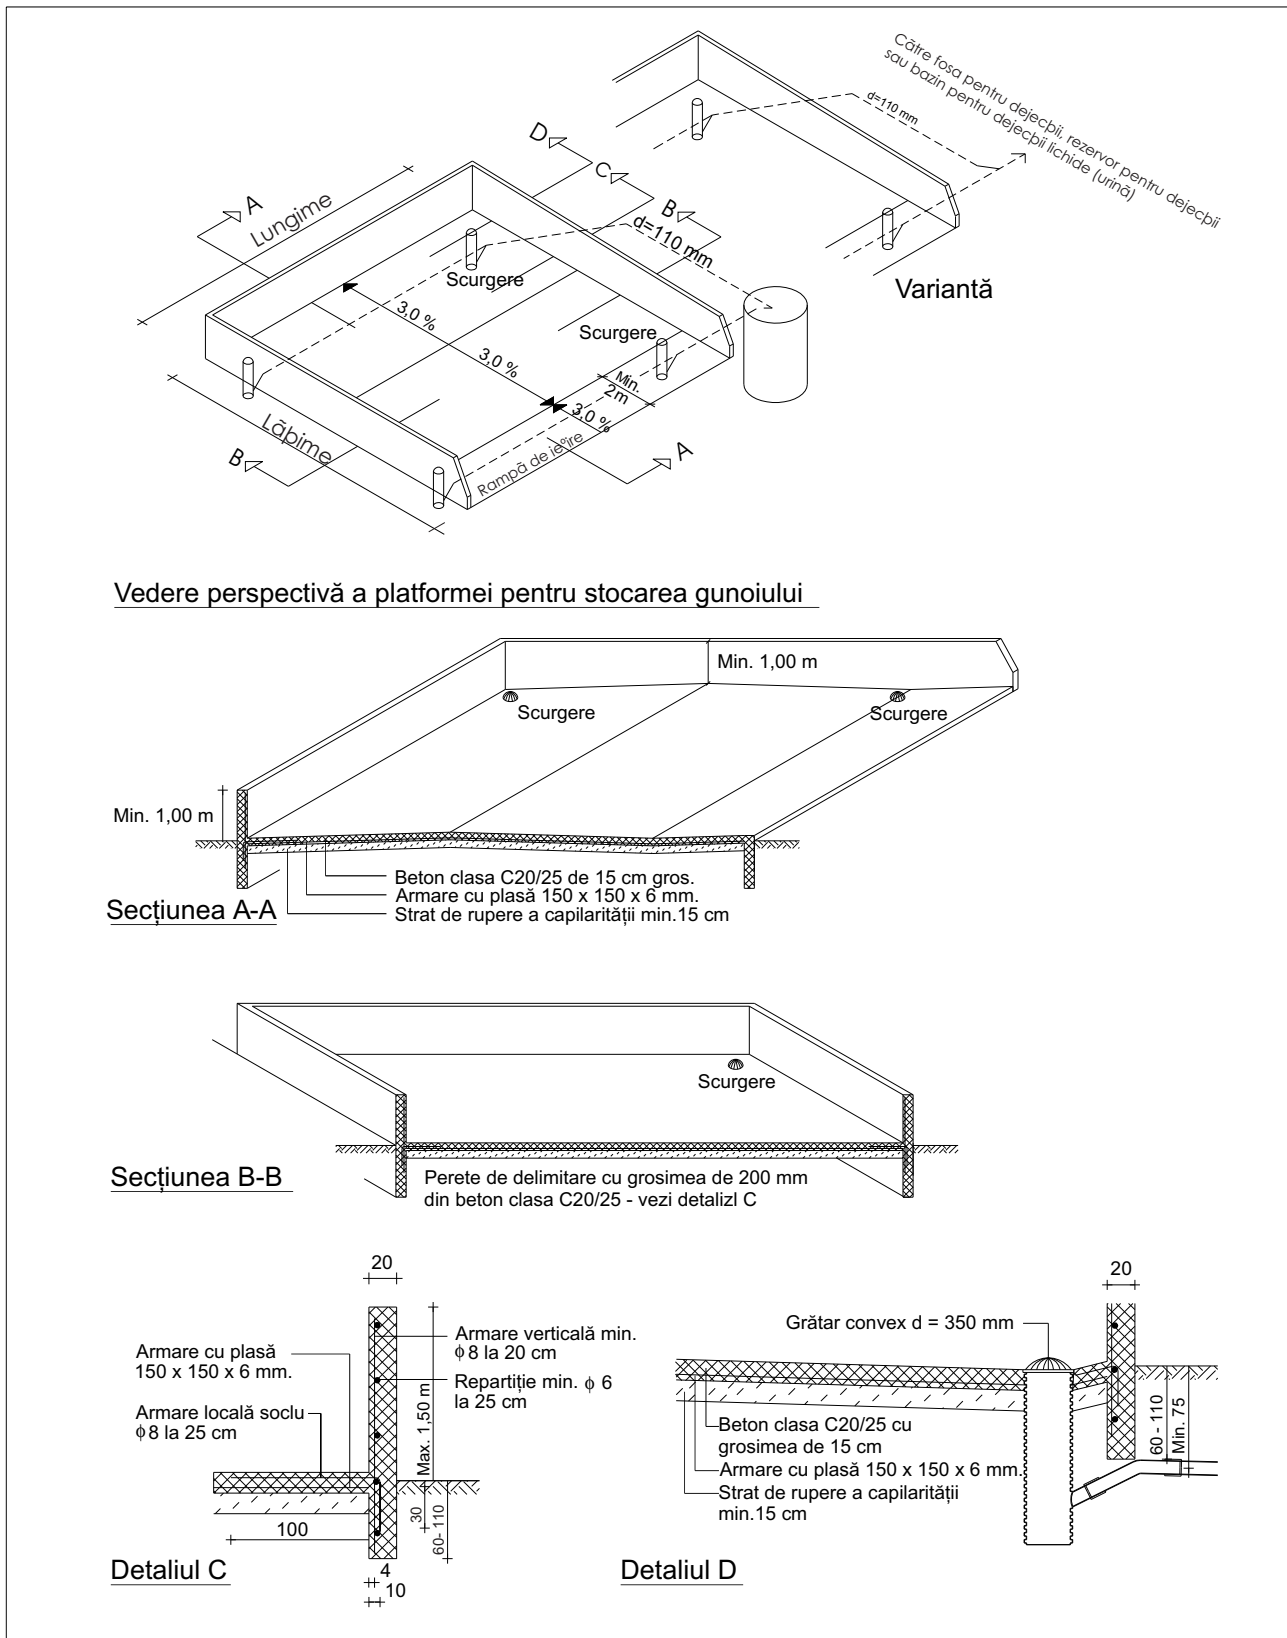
Exemplu de platformă pentru stocarea gunoii cu perete de delimitare înalt, turnată din beton monolit
